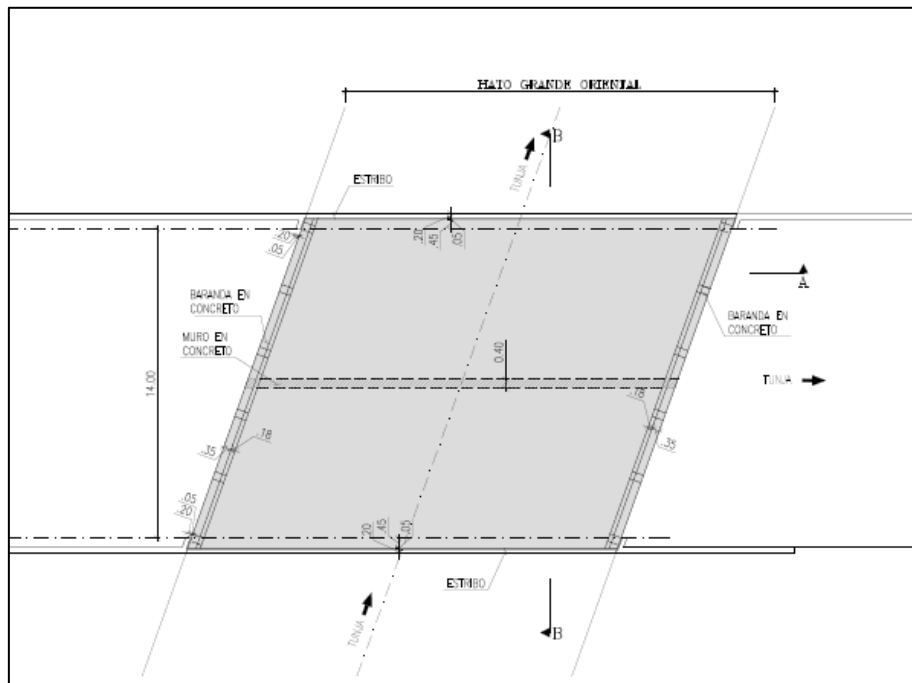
Vista en Planta Deprimido Hato Grande Oriental
